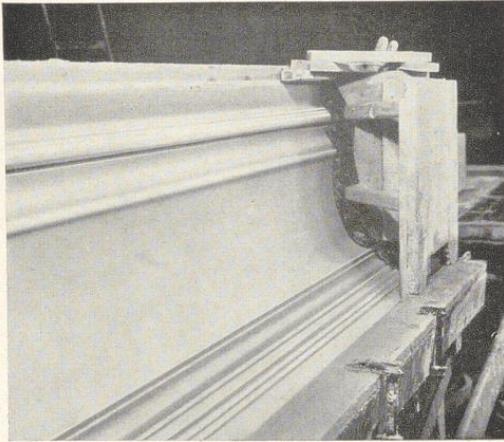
Hoher Tischzug mit gut verstreuter Mittelschablone
